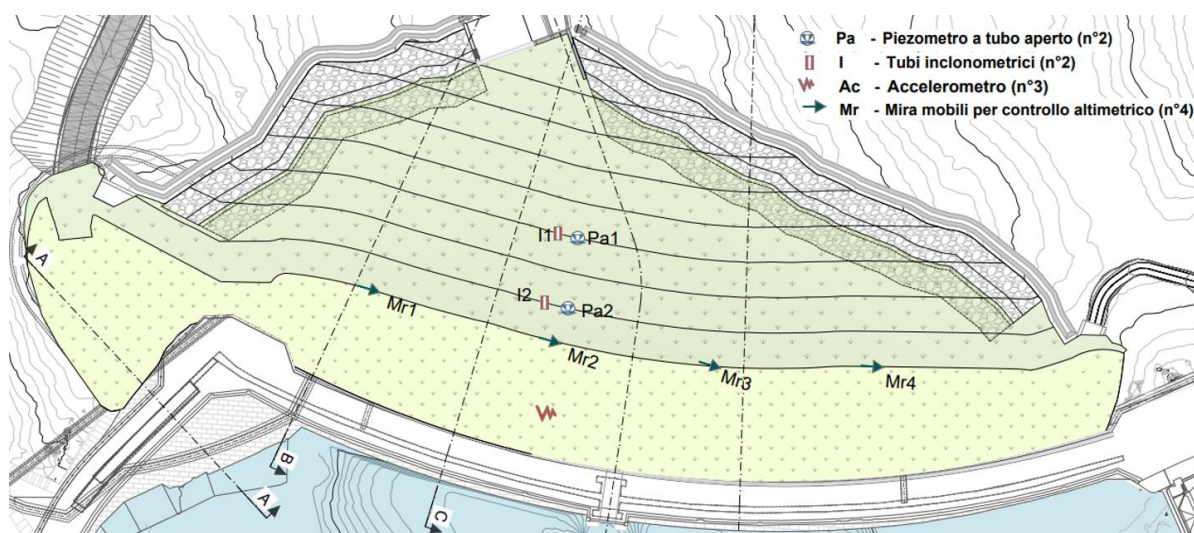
Rilevato: planimetria con indicazione della tipologia dell'ubicazione della strumentazione di monitoraggio (esistente e di nuova installazione)
